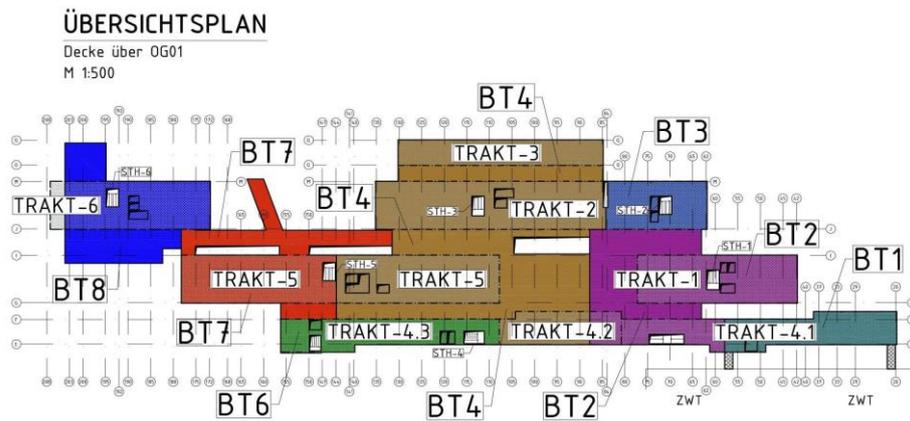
MED CAMPUS - Modul 1 Übersichtsplan Bauteil 1-8
